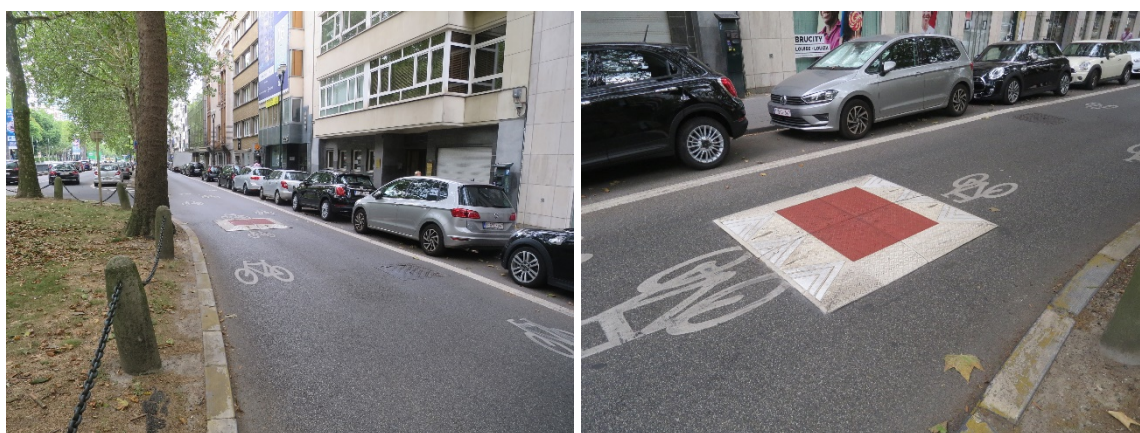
Coussin unique fixé sur une chaussée d'une largeur de 3,70 m
